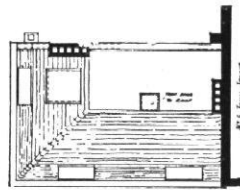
/ Wohnhaus in London Mayfair, No. 6 John Street
